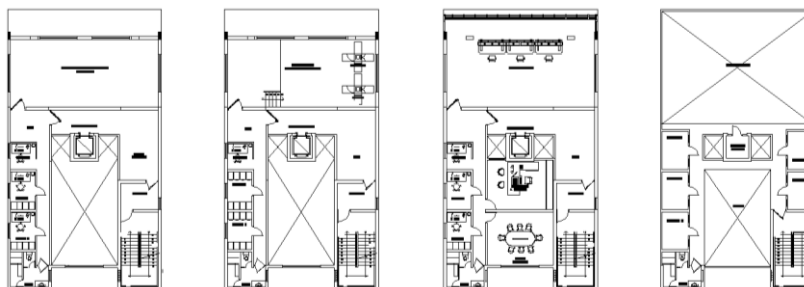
Segunda planta del edificio de control de la zona E
